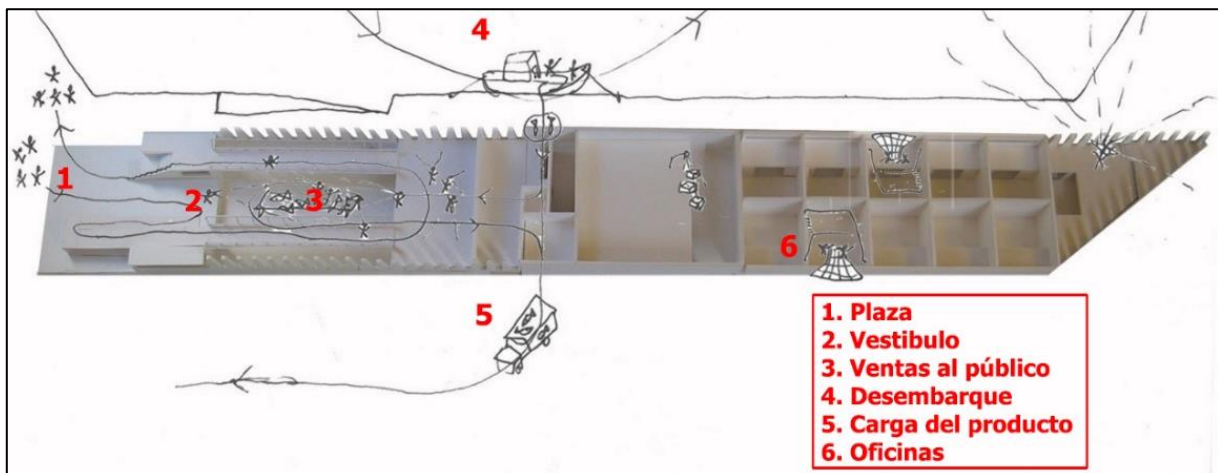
Planta 3D, esquemática y diagramación de espacios. Lonja para el puerto de Fisterra.
